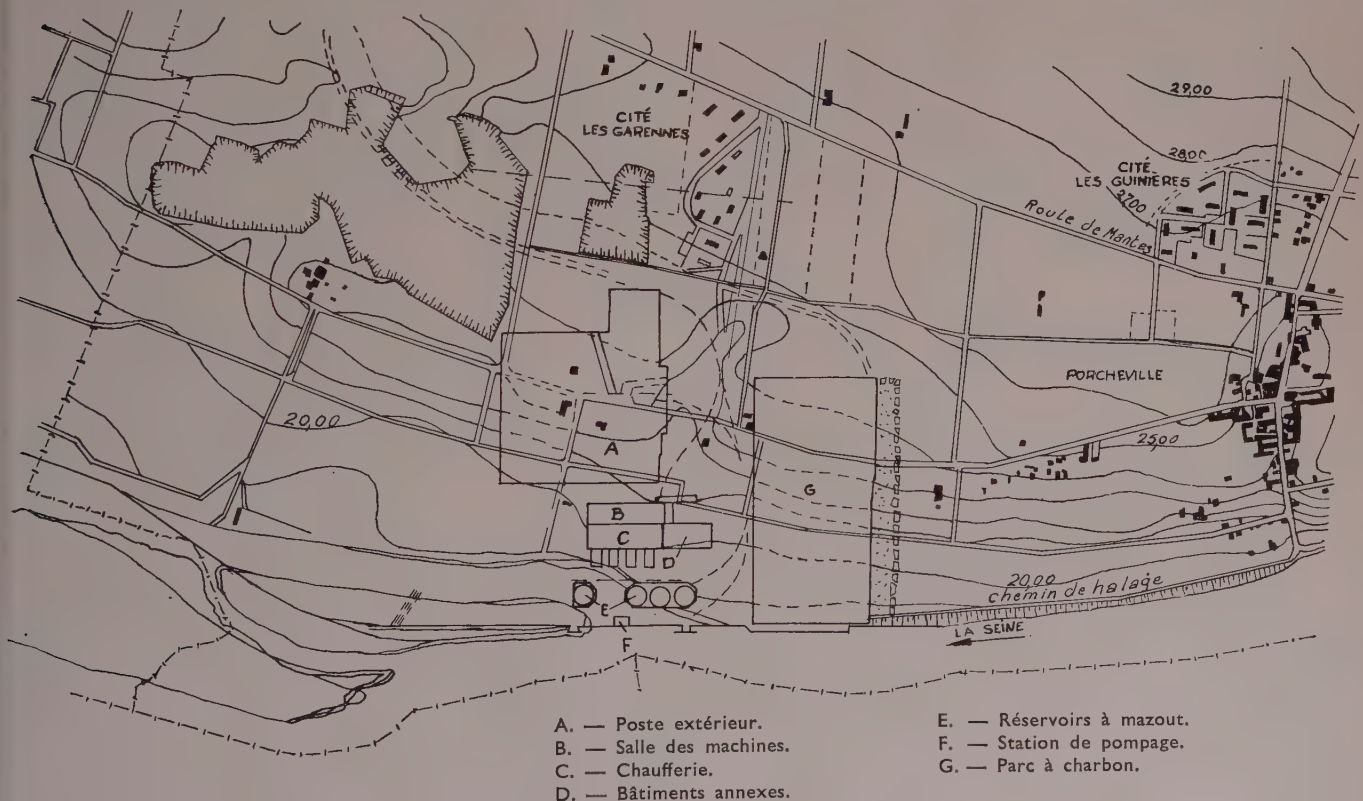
Plan de situation de la centrale de Porcheville et de ses abords.
